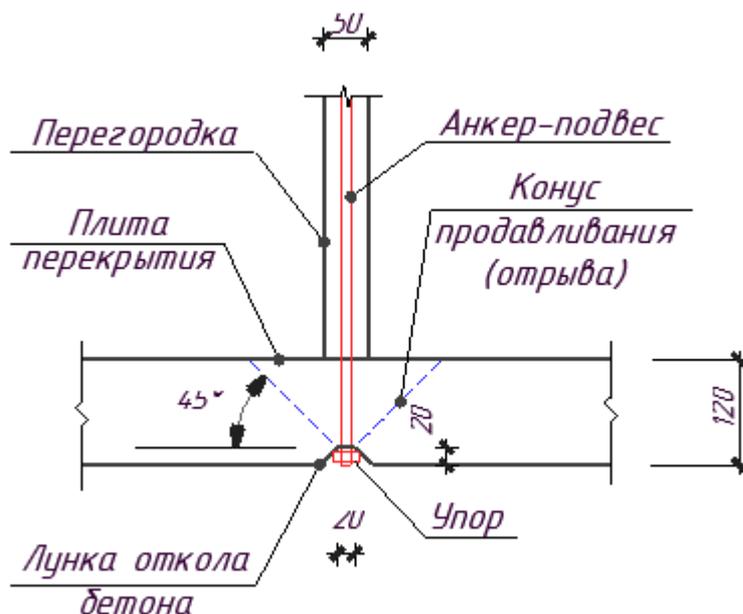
Выпуски анкерных стержней для устройства перегородки
